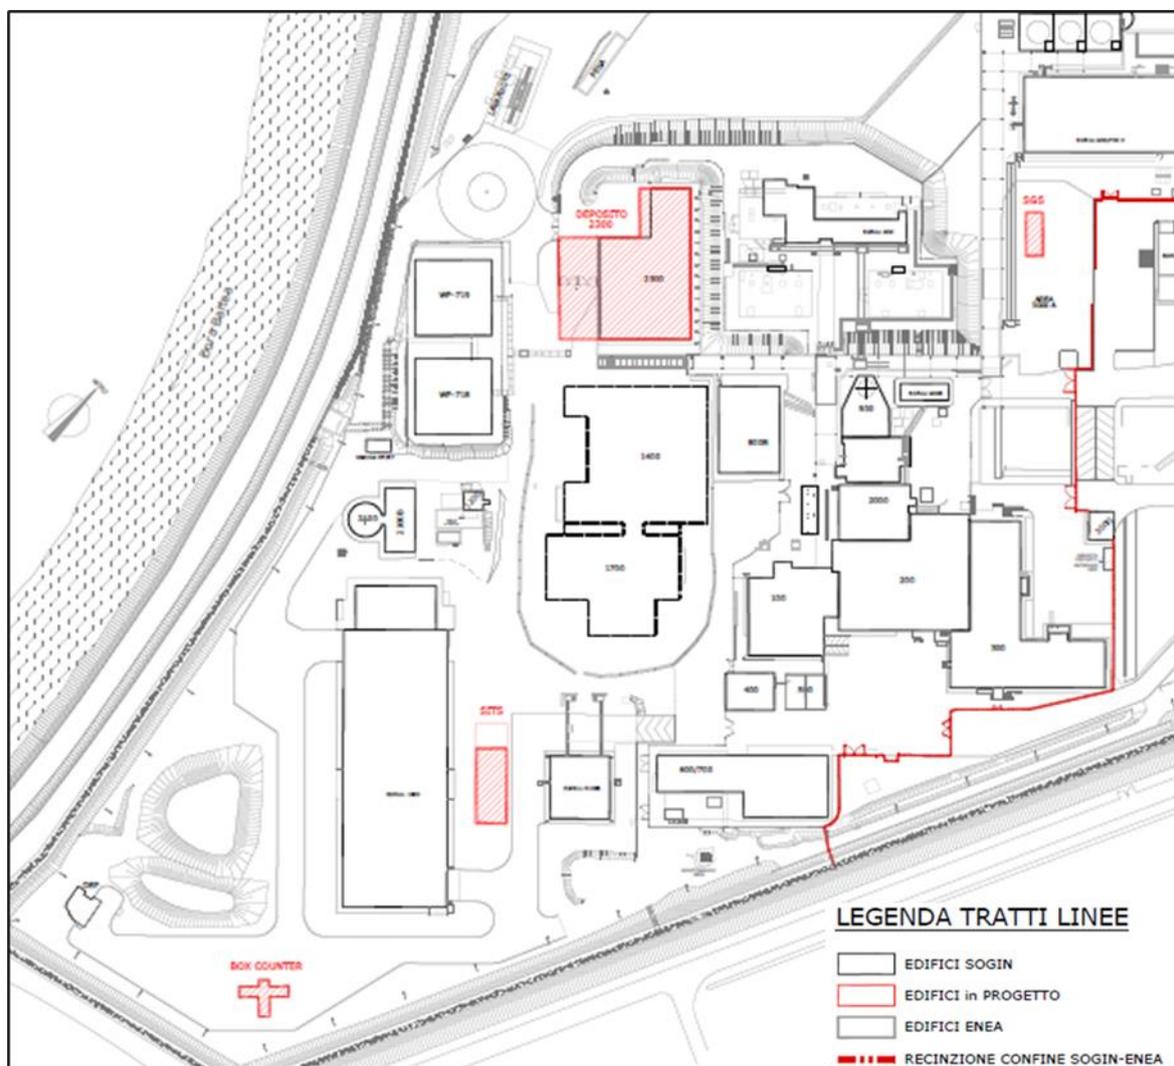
Planimetria del Sito Eurex con ubicazione delle facilities e del deposito 2300
